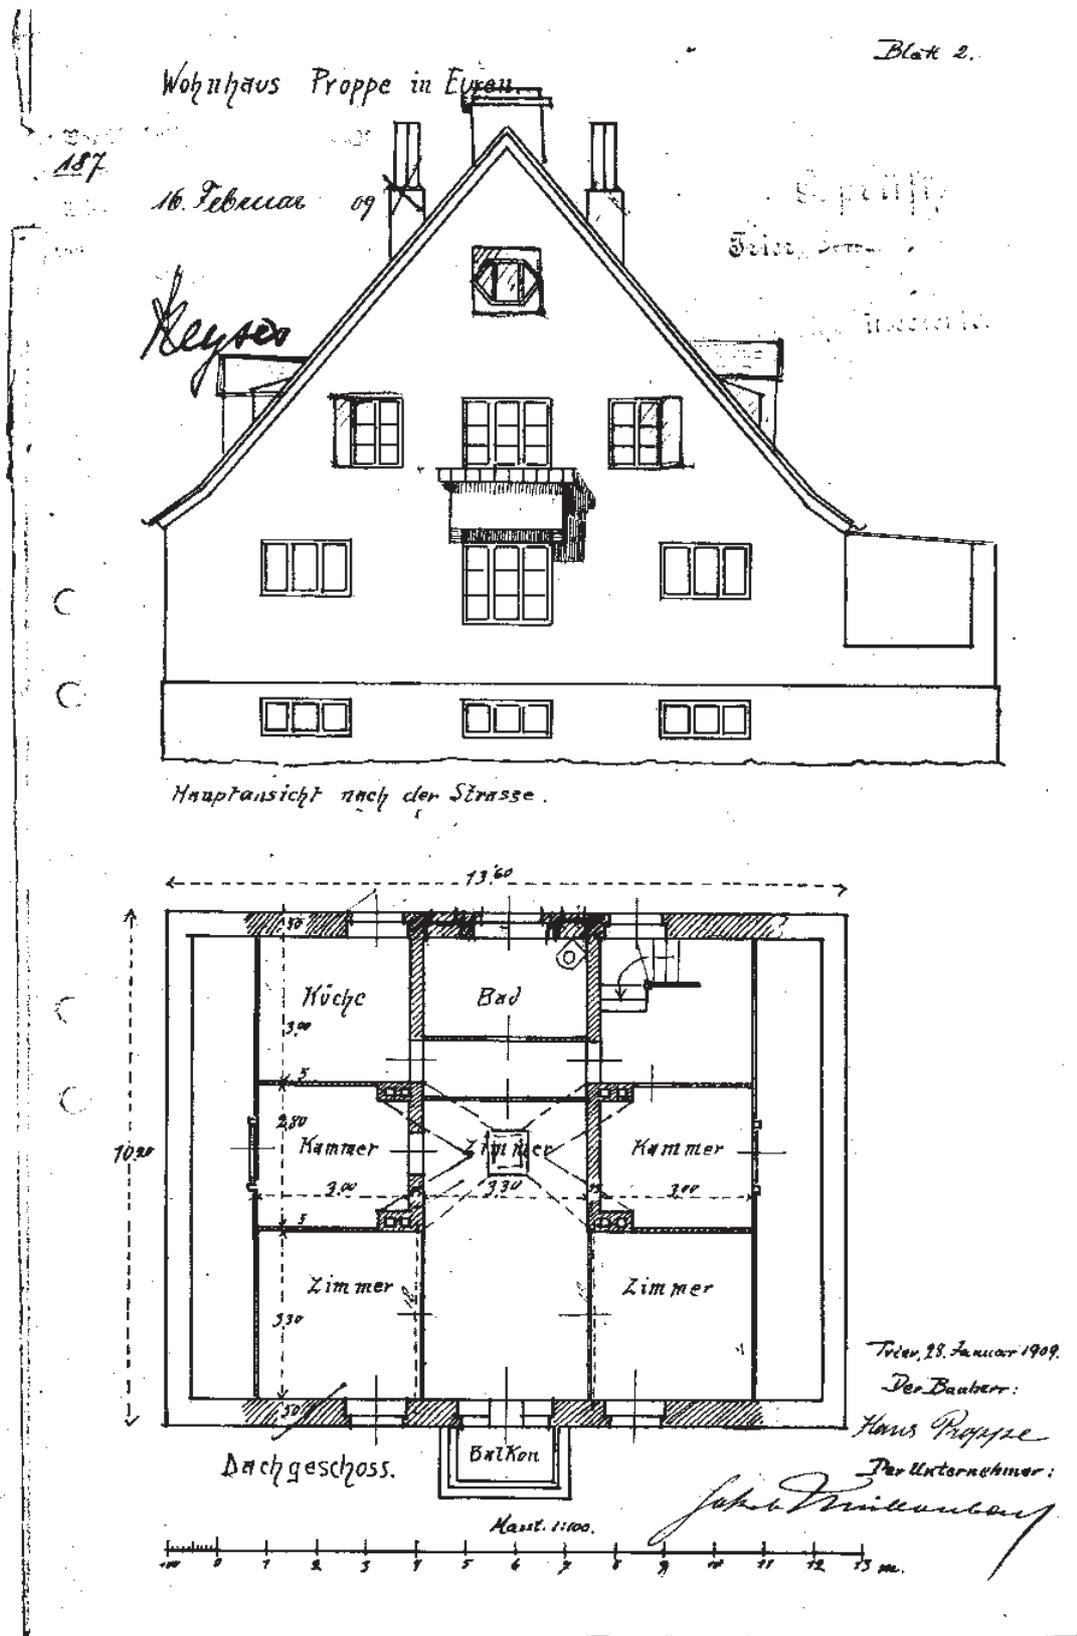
Haus Proppe, Bauplan, Blatt 2, Hauptansicht von der Straße und Grundriss Dachgeschoss
